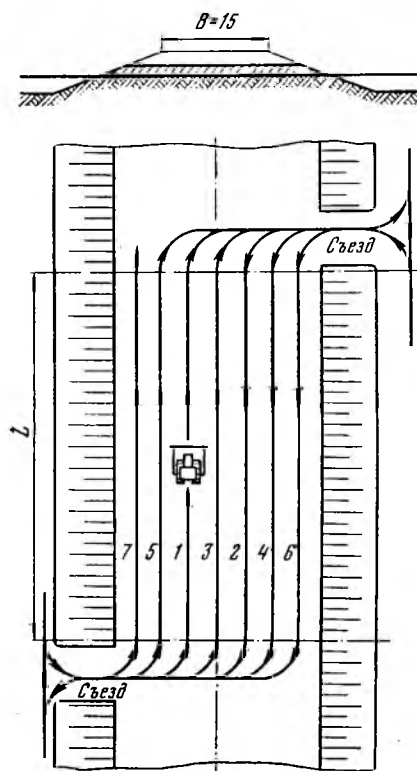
Схема послойного разравнивания грунта в насыпи бульдозером:
